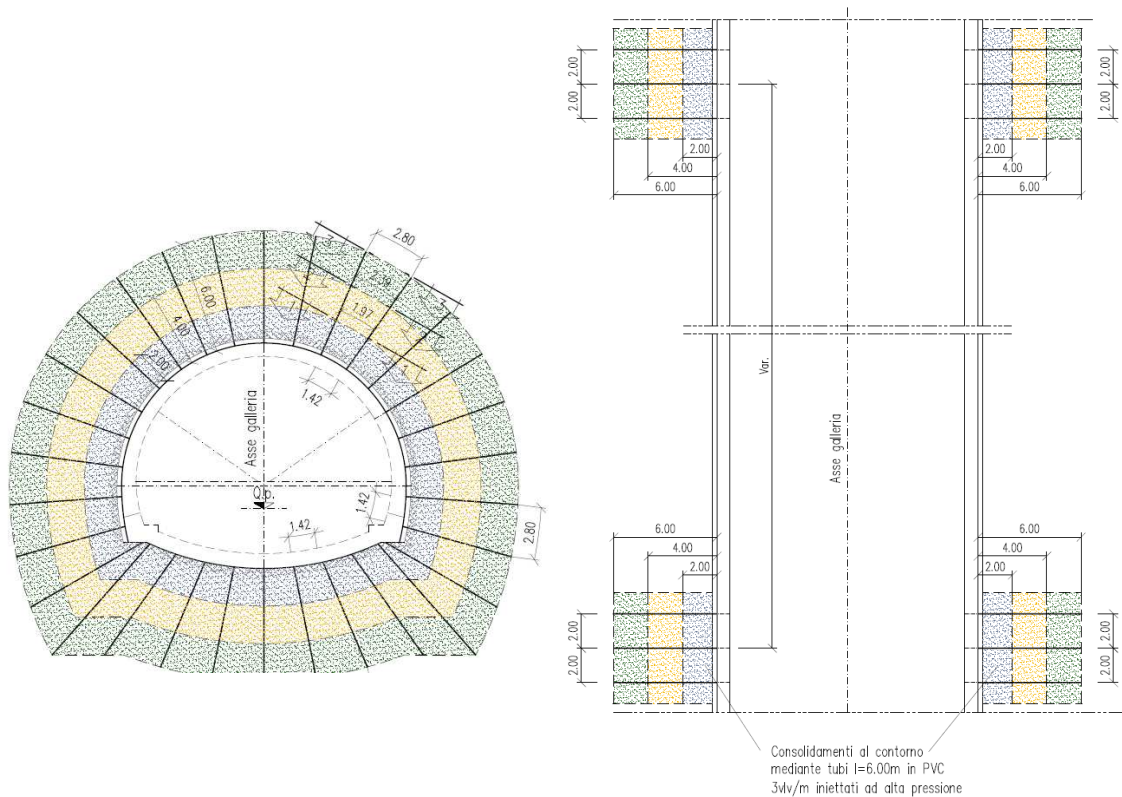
Schermi di Impermeabilizzazione radiali (Vista in sezione trasversale e in pianta)
